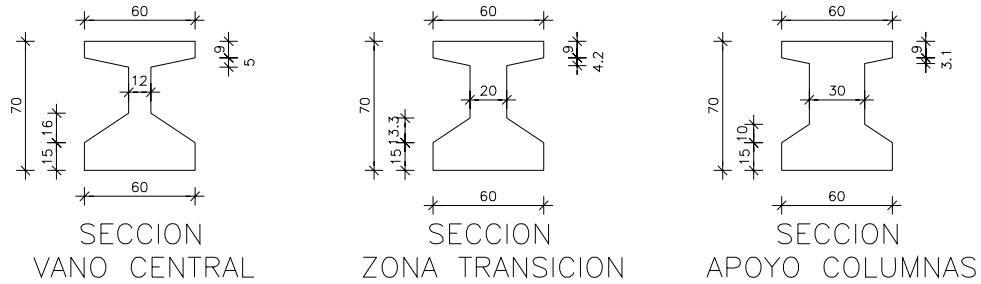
Cortes Viga Predominante, Acceso Sur Tramo Soterrado
